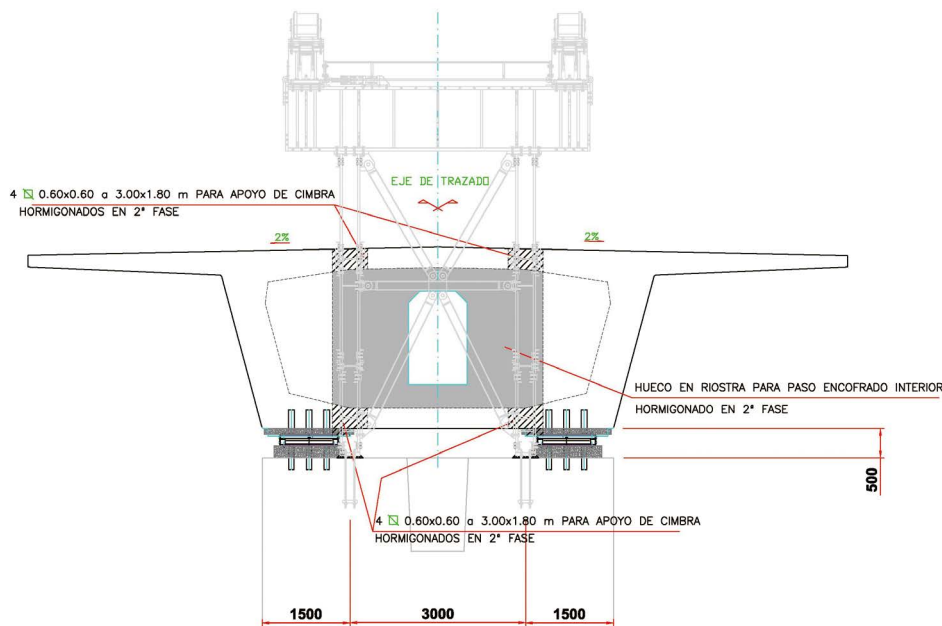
Interferencia entre el tablero en ejecución y el pórtico de apoyo de pila.
